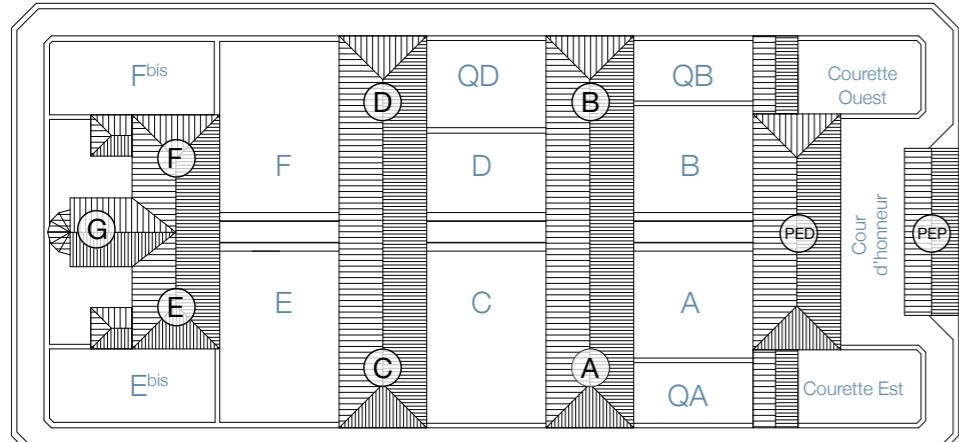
Plan de toiture et plan des cours d'origine supposé, deuxième moitié du XIXème siècle. Source : Croisée d'archi
